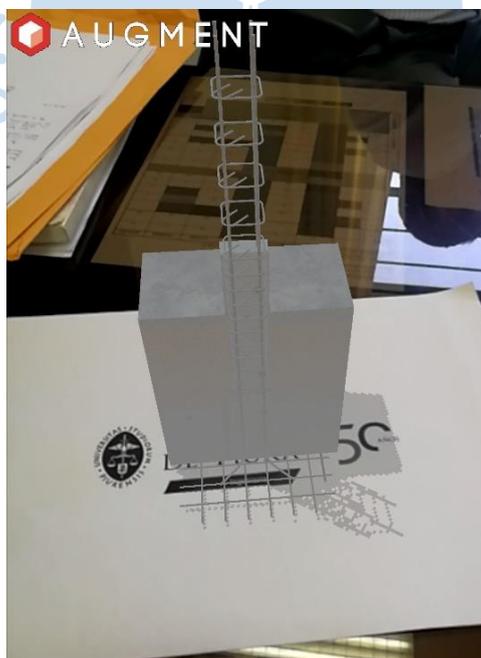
Modelo en realidad aumentada de zapata con columna, con tracker.
